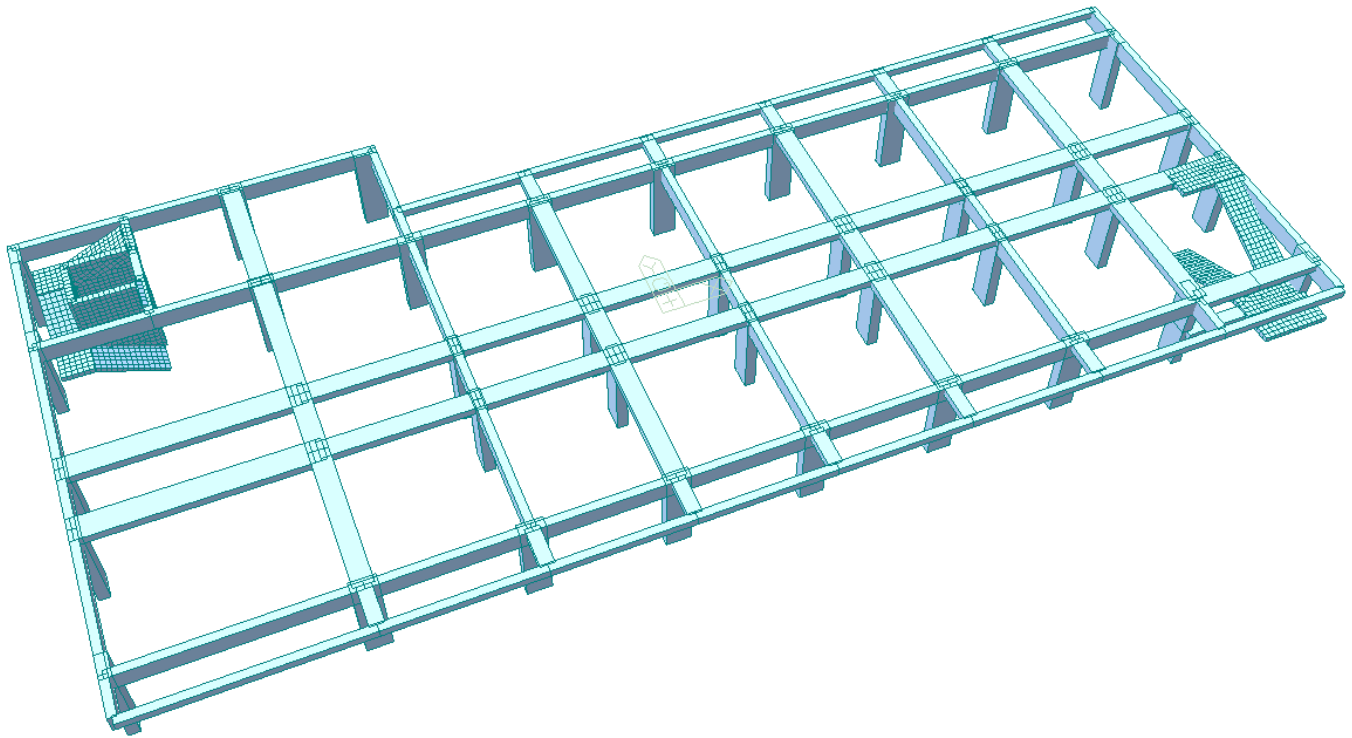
Modello FEM: vista tridimensionale estrusa del piano terra
